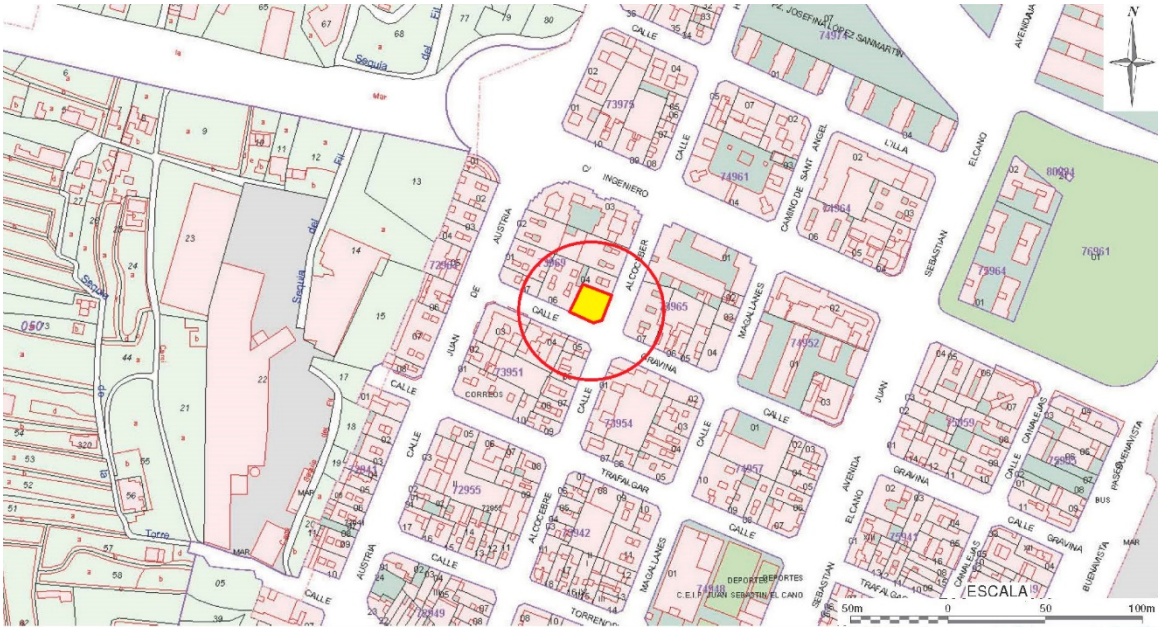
Plano de Emplazamiento y Situación del Edificio situado en la C/ Alcocebre, 45. Fuente: sedecatastro.gob.es
